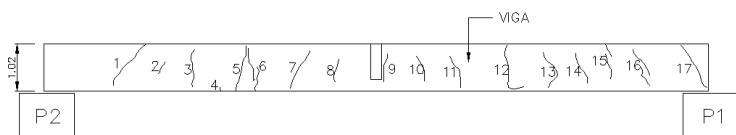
Levantamiento fisuras en viga No. 1 entre ejes P1 y P2 (vano No. 2), cara interna.
